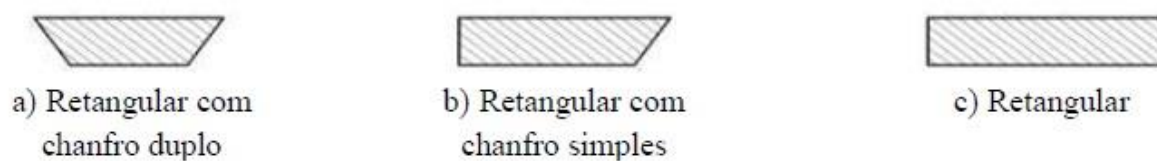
Exemplos de secções transversais dos fasquios (tábuas horizontais) [8]
